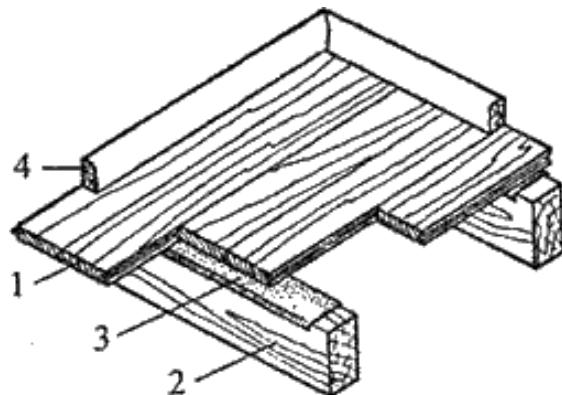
Цокольное перекрытие по балкам: 1 — доска пола; 2 — балка; 3 — рубероид; 4 — плинтус.
